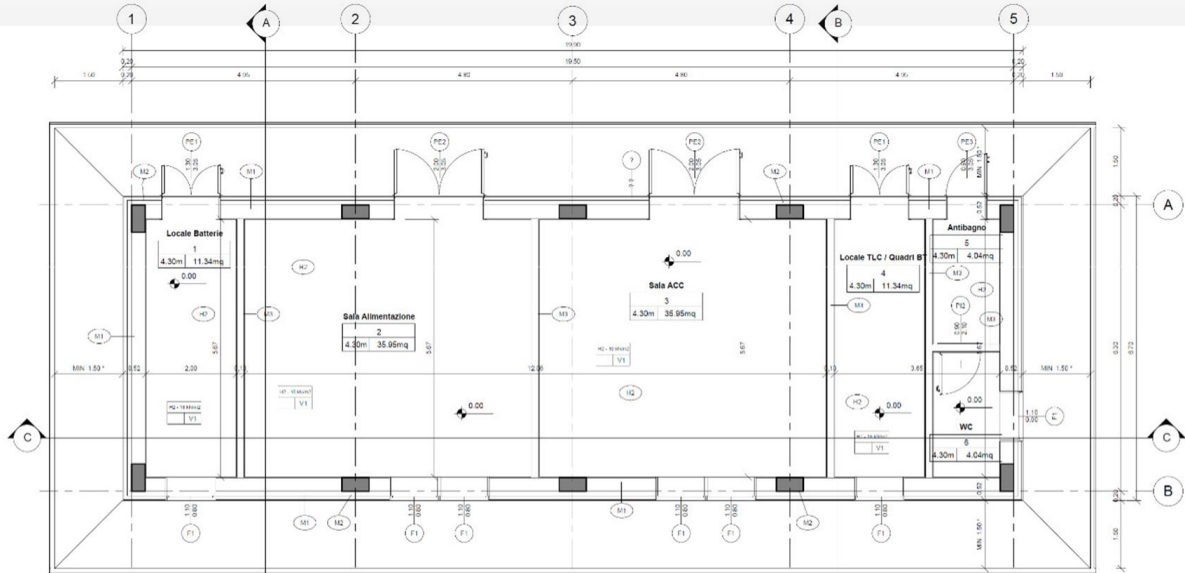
Pianta Architettonica Piano Terra – Layout Fabbricato FA01
